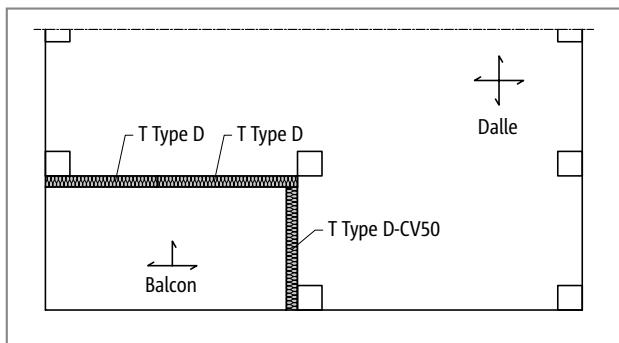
Schöck Isokorb® T Type D : Utilisation dans des planchers plats
